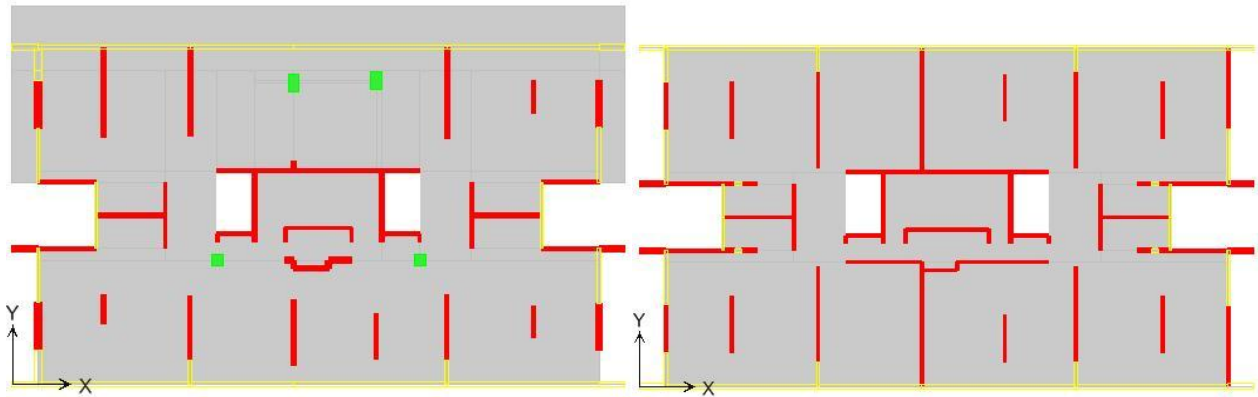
Planta primer piso (izquierda) y piso tipo (derecha) edificio H1
